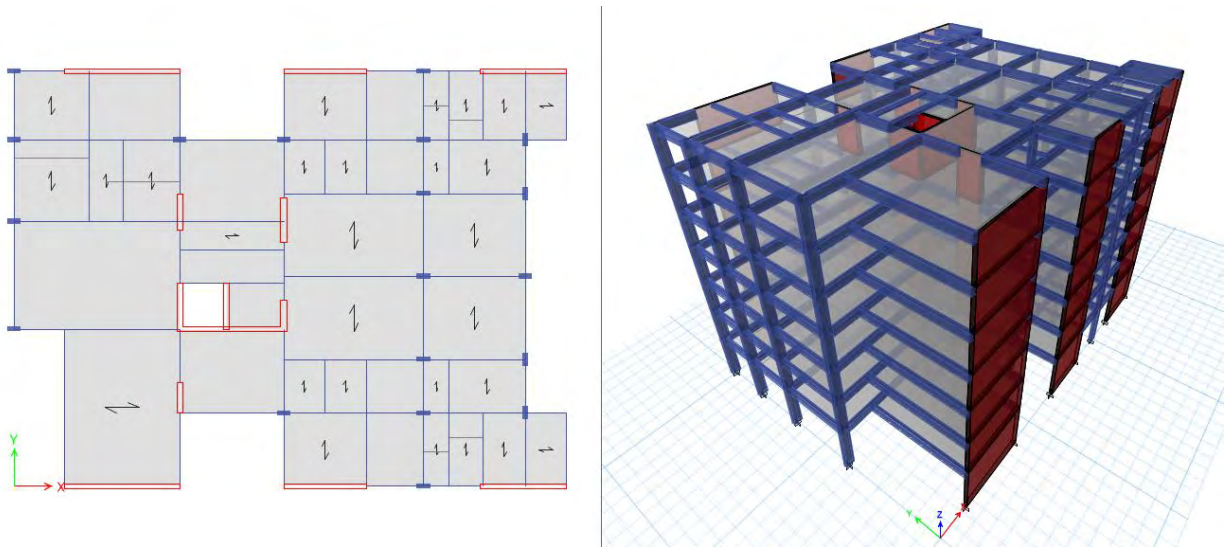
Modelo en planta y en tres dimensiones de la estructura
